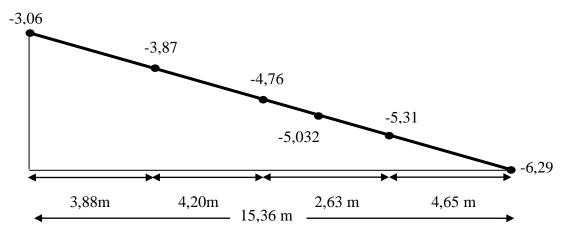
Coupe transversale de la rampe d'accès des deux sous-sols.
